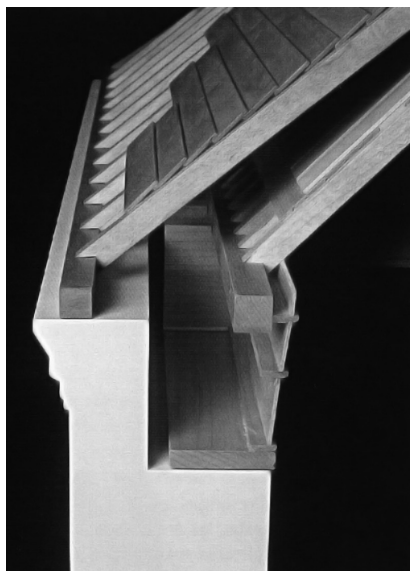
Maqueta de detalle constructivo tipo de doble estructura (E. Nuere en *La Carpintería de armar española*).
